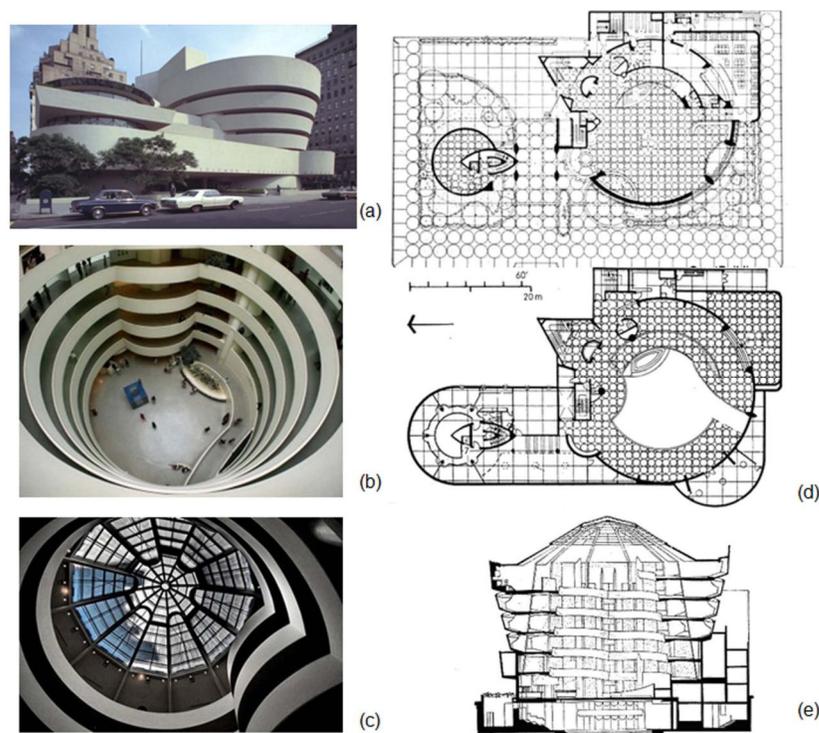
Frank Lloyd Wright, Museo Guggenheim, Nueva York, E.U.A. (1943-1959): (a) Vista exterior, (b) Vista interior hacia el lobby, (c) Vista interior hacia el domo, (d) Plantas arquitectónicas, (e) Sección transversal.
